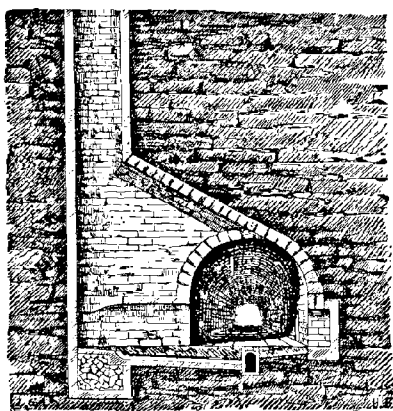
Coupe d'un puits d'aérage d'un tunnel.
